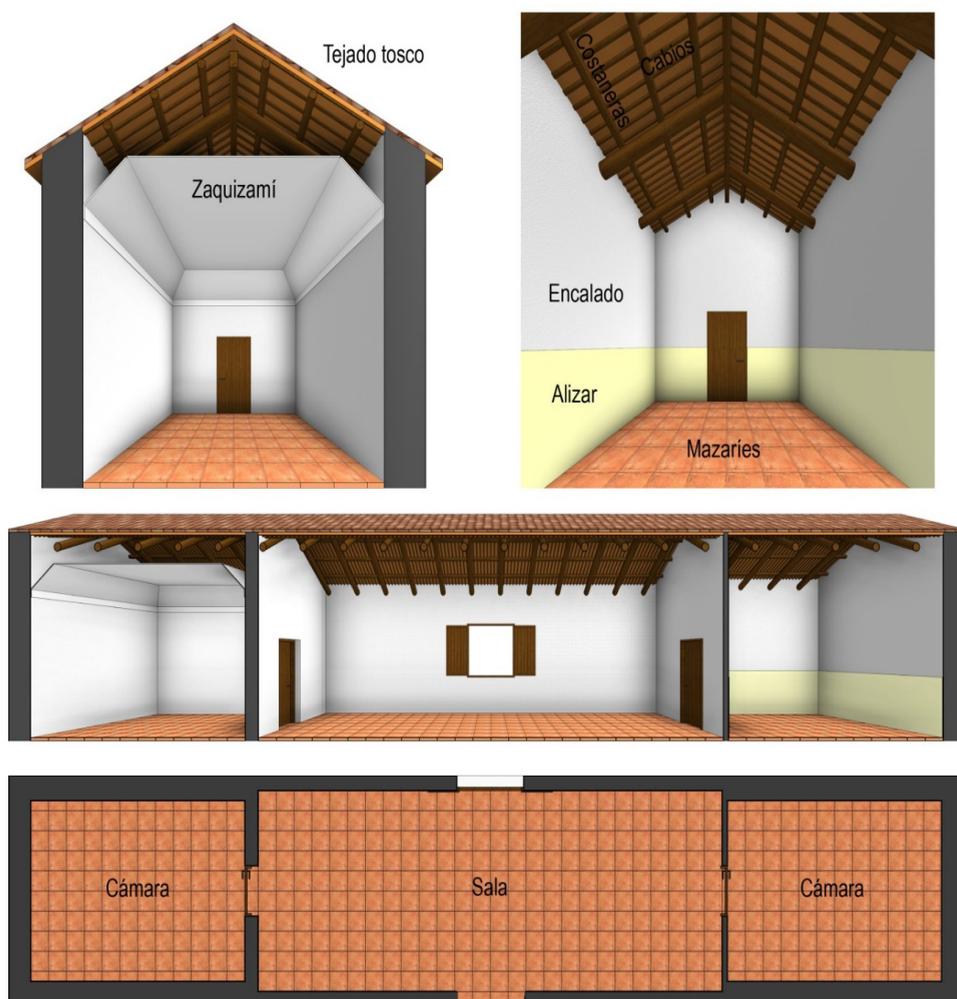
Perspectivas seccionadas (vistas transversales y longitudinales) y planta de dos cámaras en planta alta, con puertas tablares, tejado tosco y mazaríes (según descripción ACS, MC, II, 9163, f.16r) (Mónica Marín-Ruiz).
